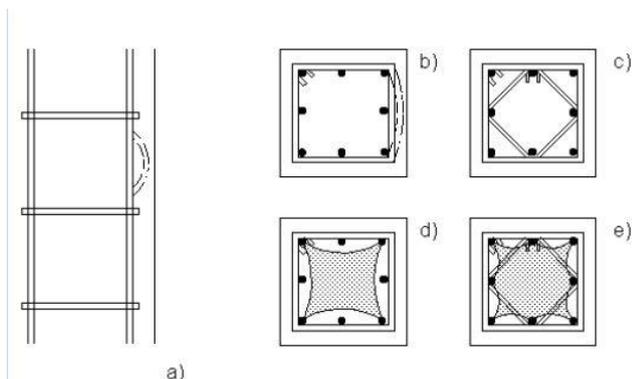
Instabilità dell'armatura longitudinale e contenimento offerto dalle staffe [26]
